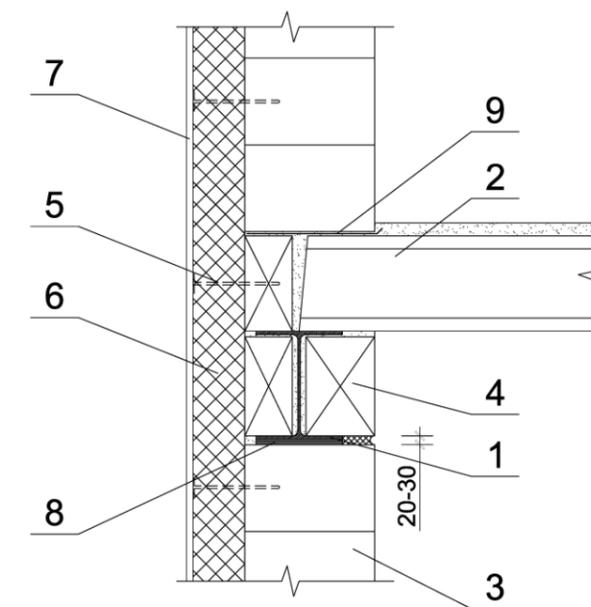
Фрагмент стенового заполнения с применением блоков ячеистого бетона и СФТК. 1- ригель, 2- плита перекрытия, 3- блоки ячеистобетонные, 4- закладка ригеля блоками, 5- дюбели пластиковые тарельчатого типа для крепления утеплителя, 6- утеплитель минераловатные плиты жесткие, 7-тонкая штукатурка, 8-упругая прокладка между ригелем и блоками, 9- гидроизоляционная прокладка. Огнезащитное покрытие условно не показано
